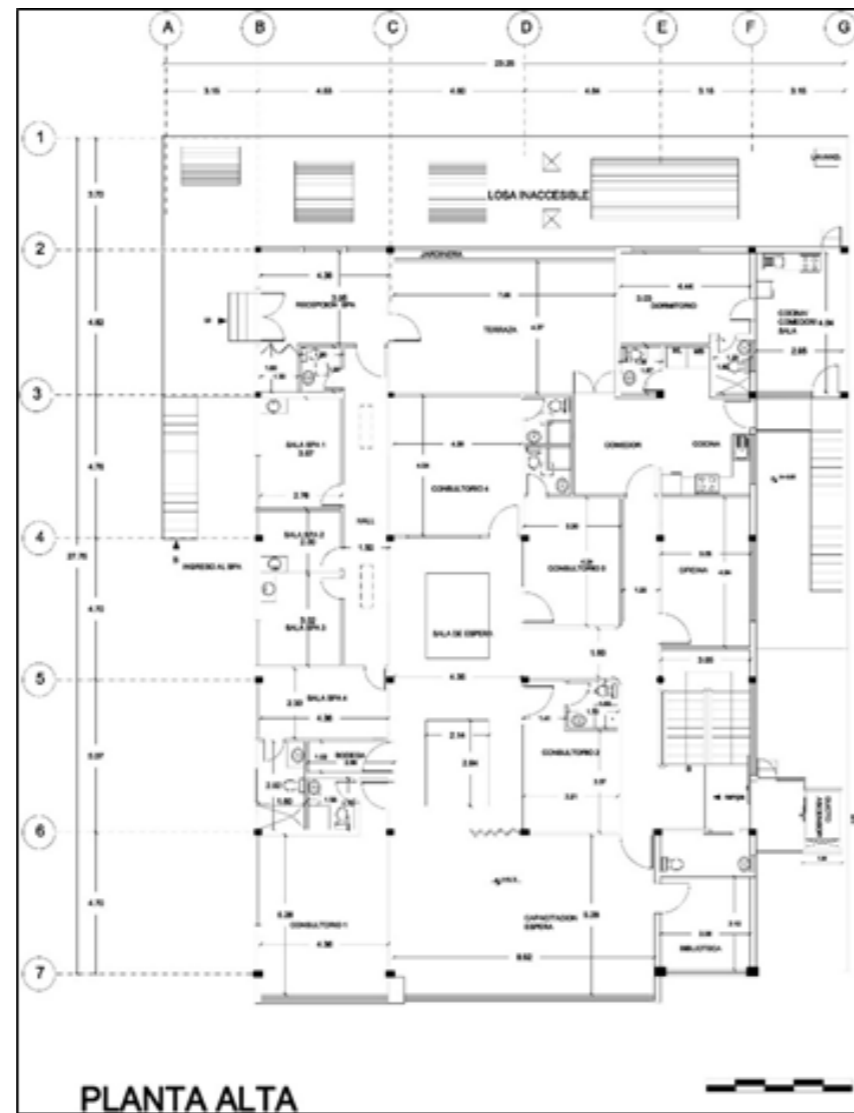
Planta alta fundación Amigos del Ecuador.
